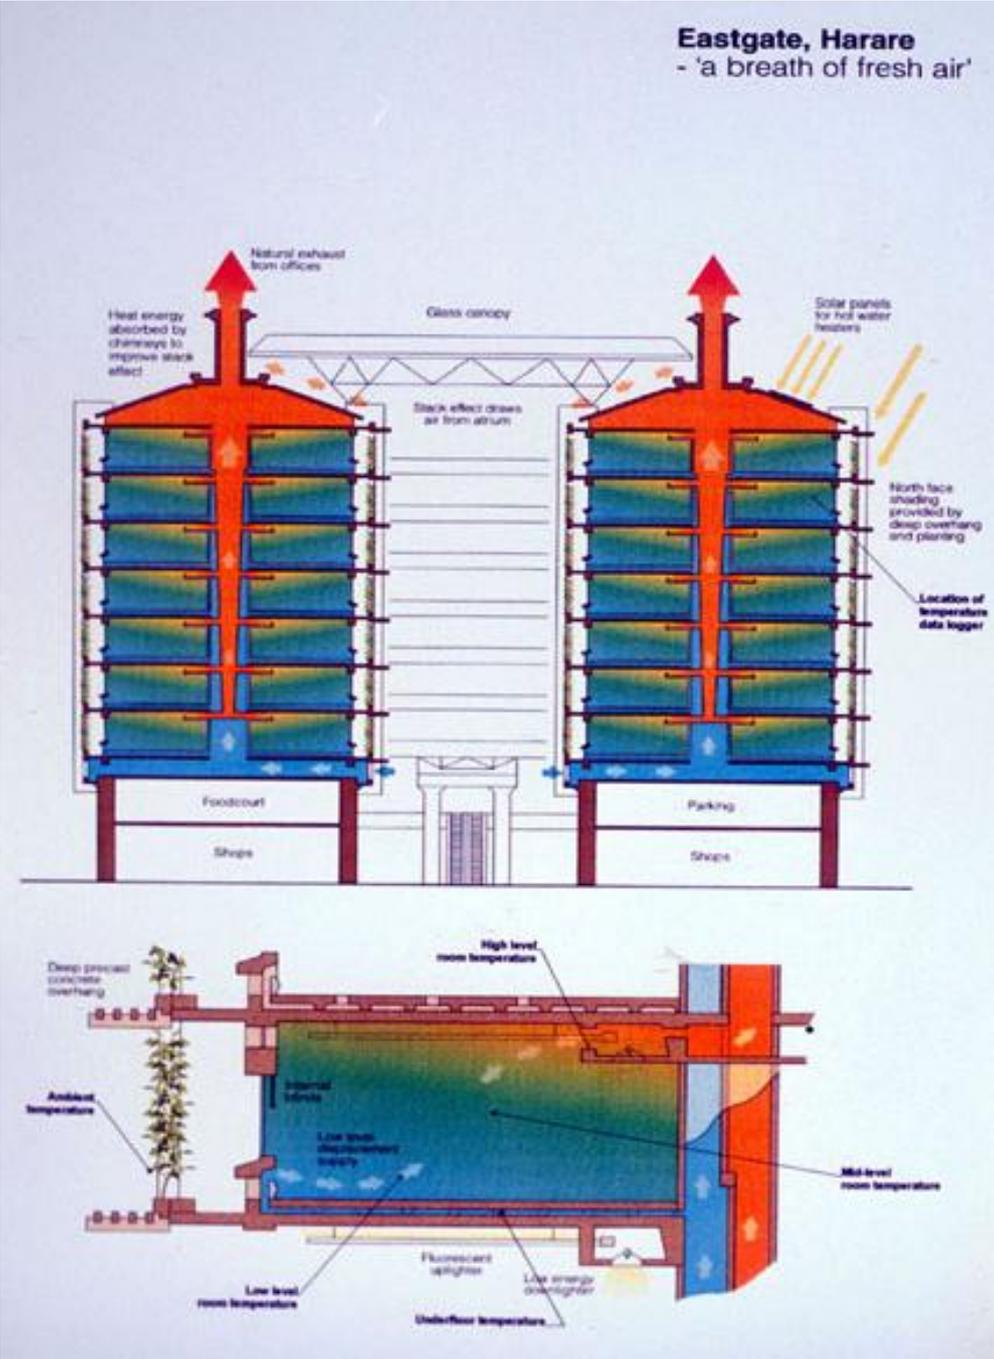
Esquema do sistema de ventilação incorporado no Eastgate Building.
